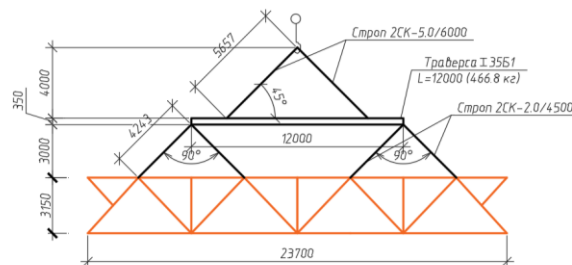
Схема строповки стальной стропильной фермы Сф-1
